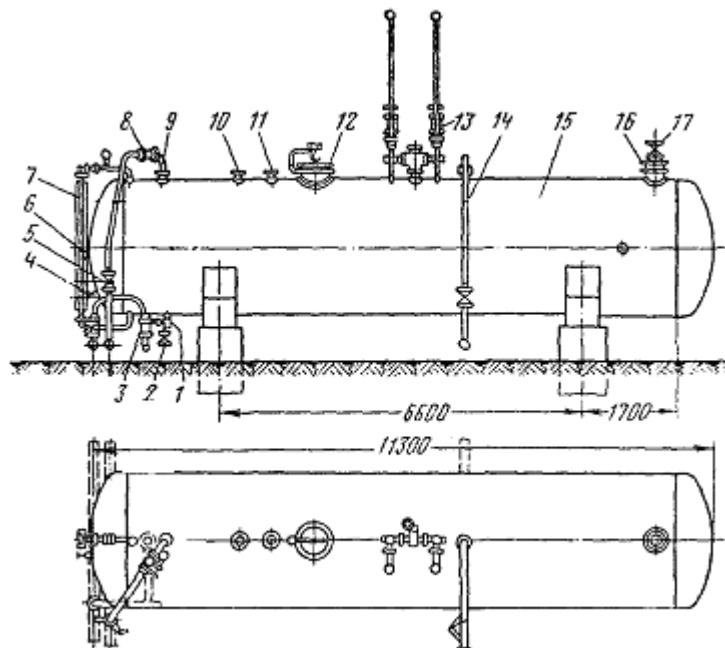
Схема установки та обв'язки надземного циліндричного резервуара.
